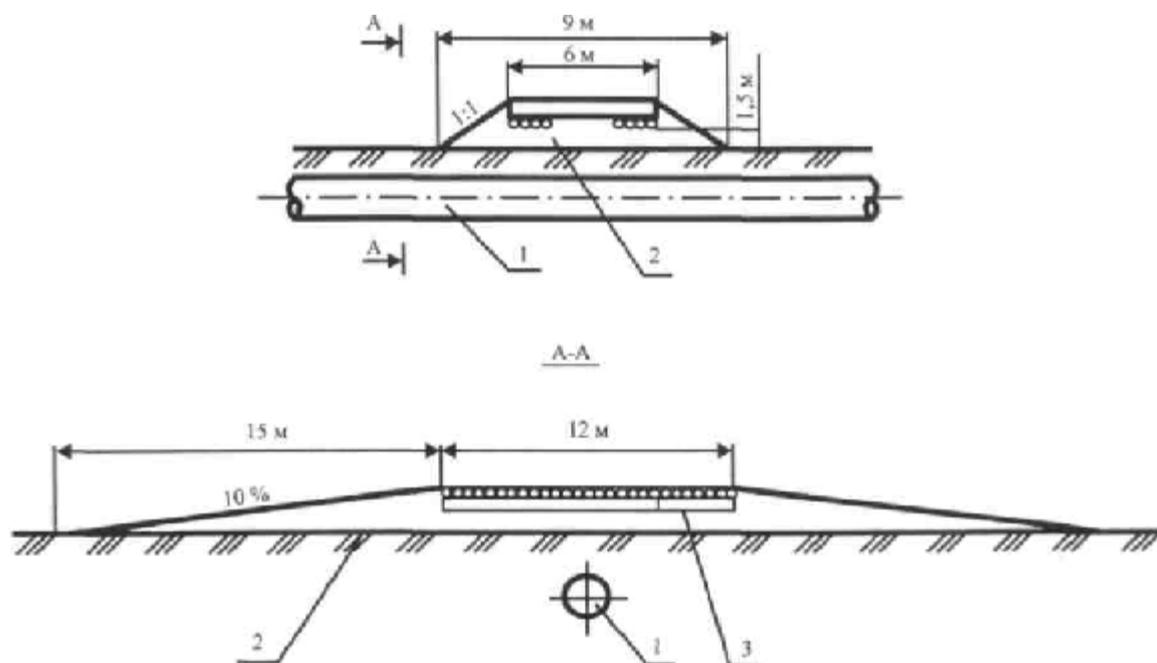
Схема конструкции проезда через действующий газопровод с применением железобетонных плит
